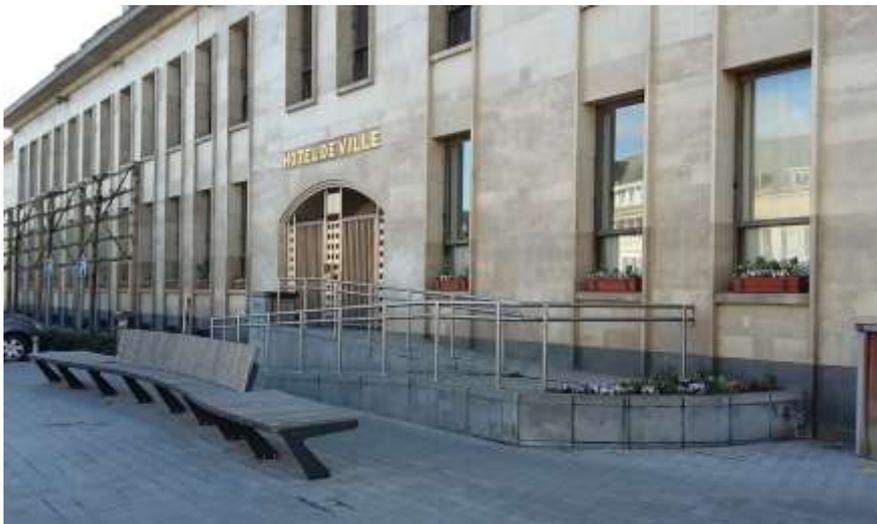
Rampe d'accès à l'Hôtel de Ville (photo Tractebel)
